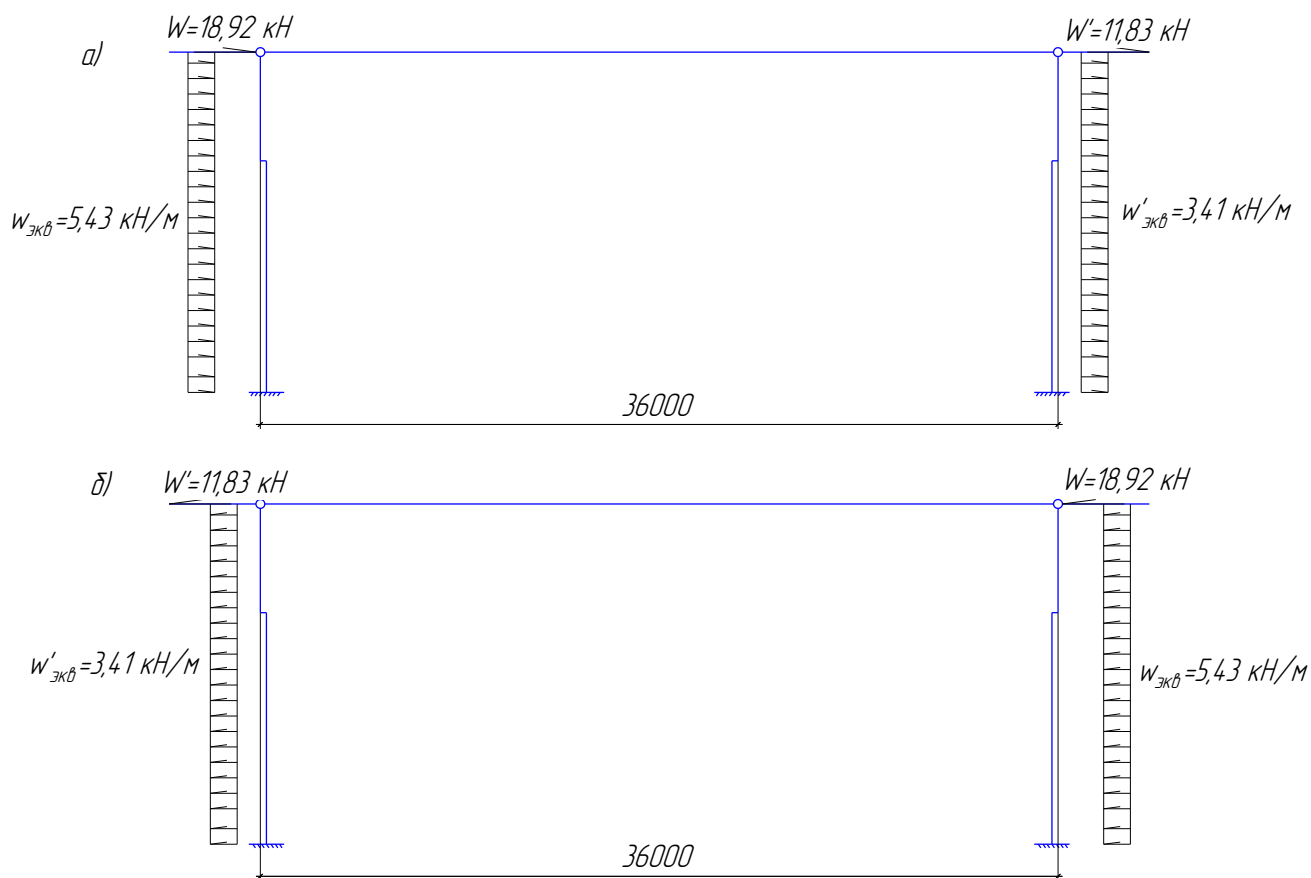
Расчетные схемы поперечной рамы на ветровую нагрузку:
